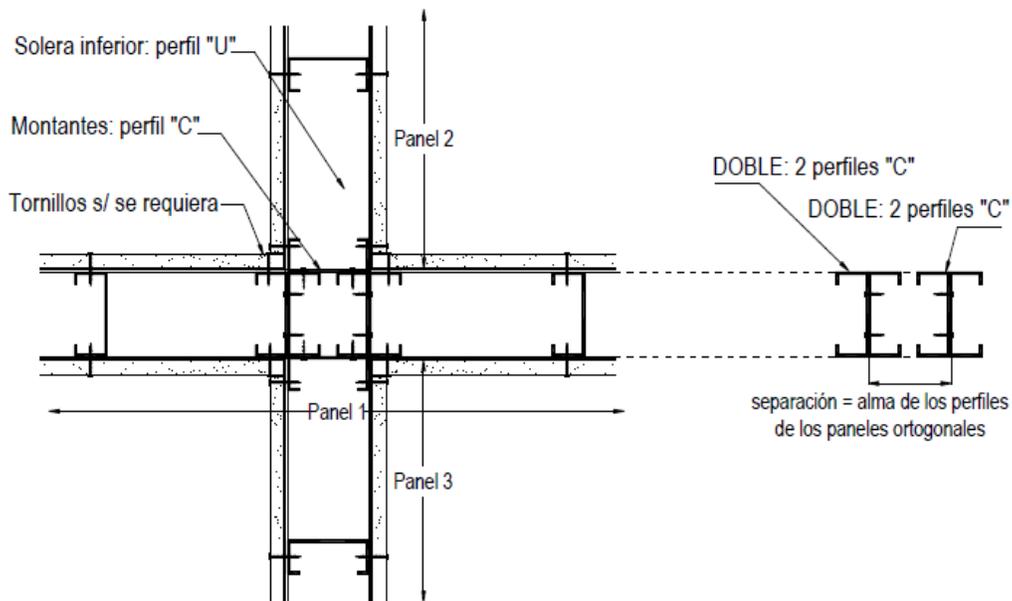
Detalle de encuentro mediante dos dobles.
